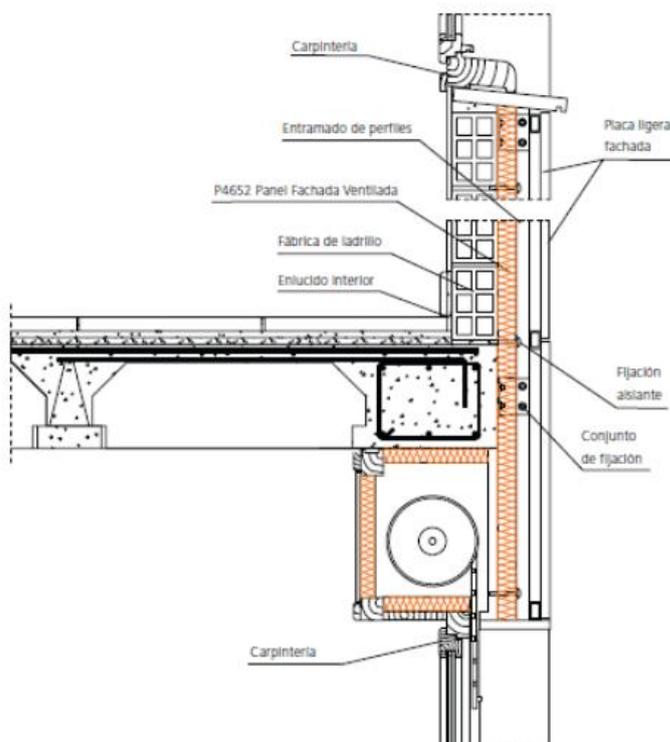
Ejemplo de detalle genérico de fachada ventilada (Fuente: Ursa)
